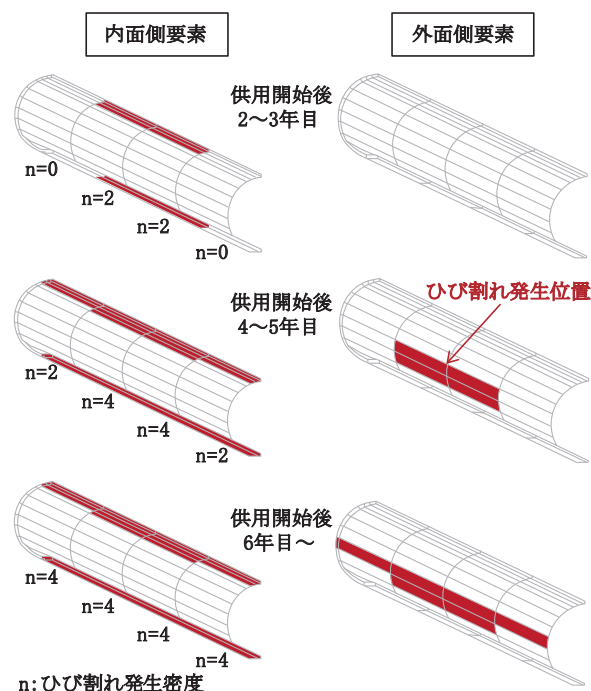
ひび割れ発生位置およびひび割れ発生密度
